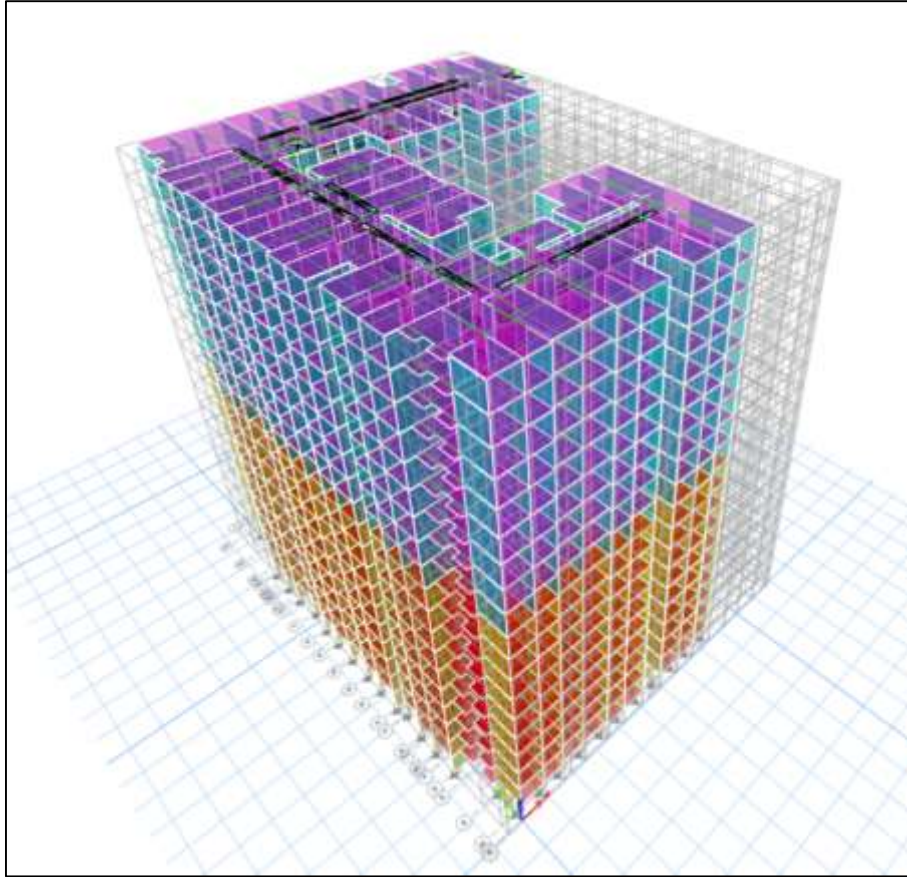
Modelo y proyección de muros de carga para proyecto Florida de la Sierra. Nota: tomado de ETABS 2018.
